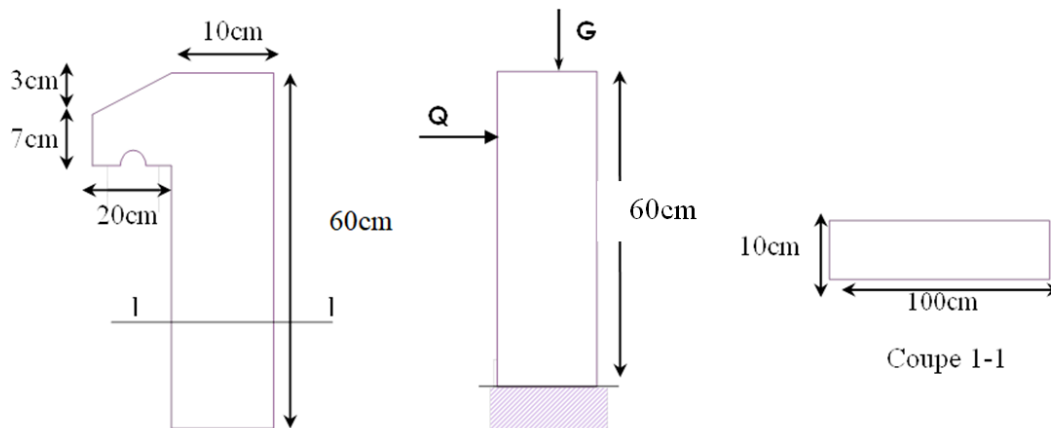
Coupe transversale et longitudinale de l'acrotère.
